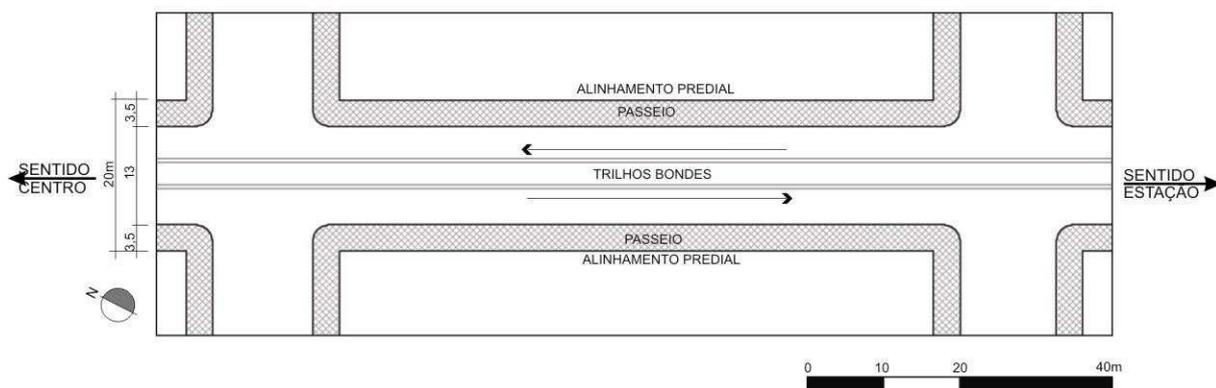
Detalhe em planta baixa da caixa da via da Rua Barão do Rio Branco. Recorte temporal: 1887 a 1952
